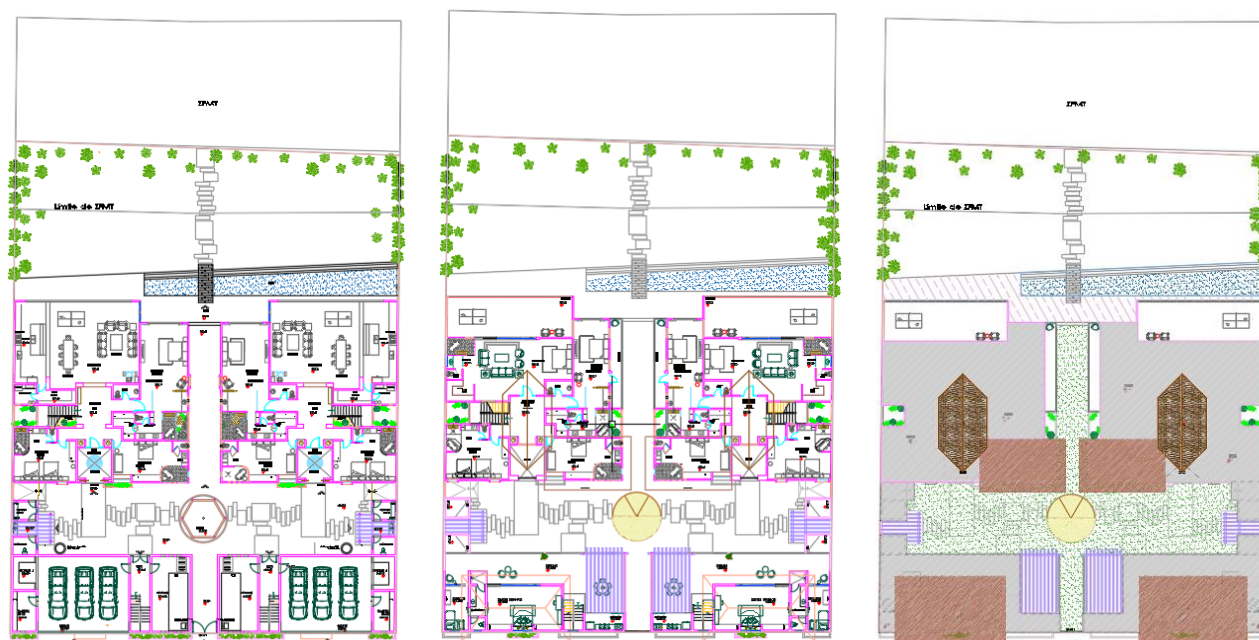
Planta baja, planta alta y azoteas de las obras permanentes del proyecto *Casa Al Ratito*.
